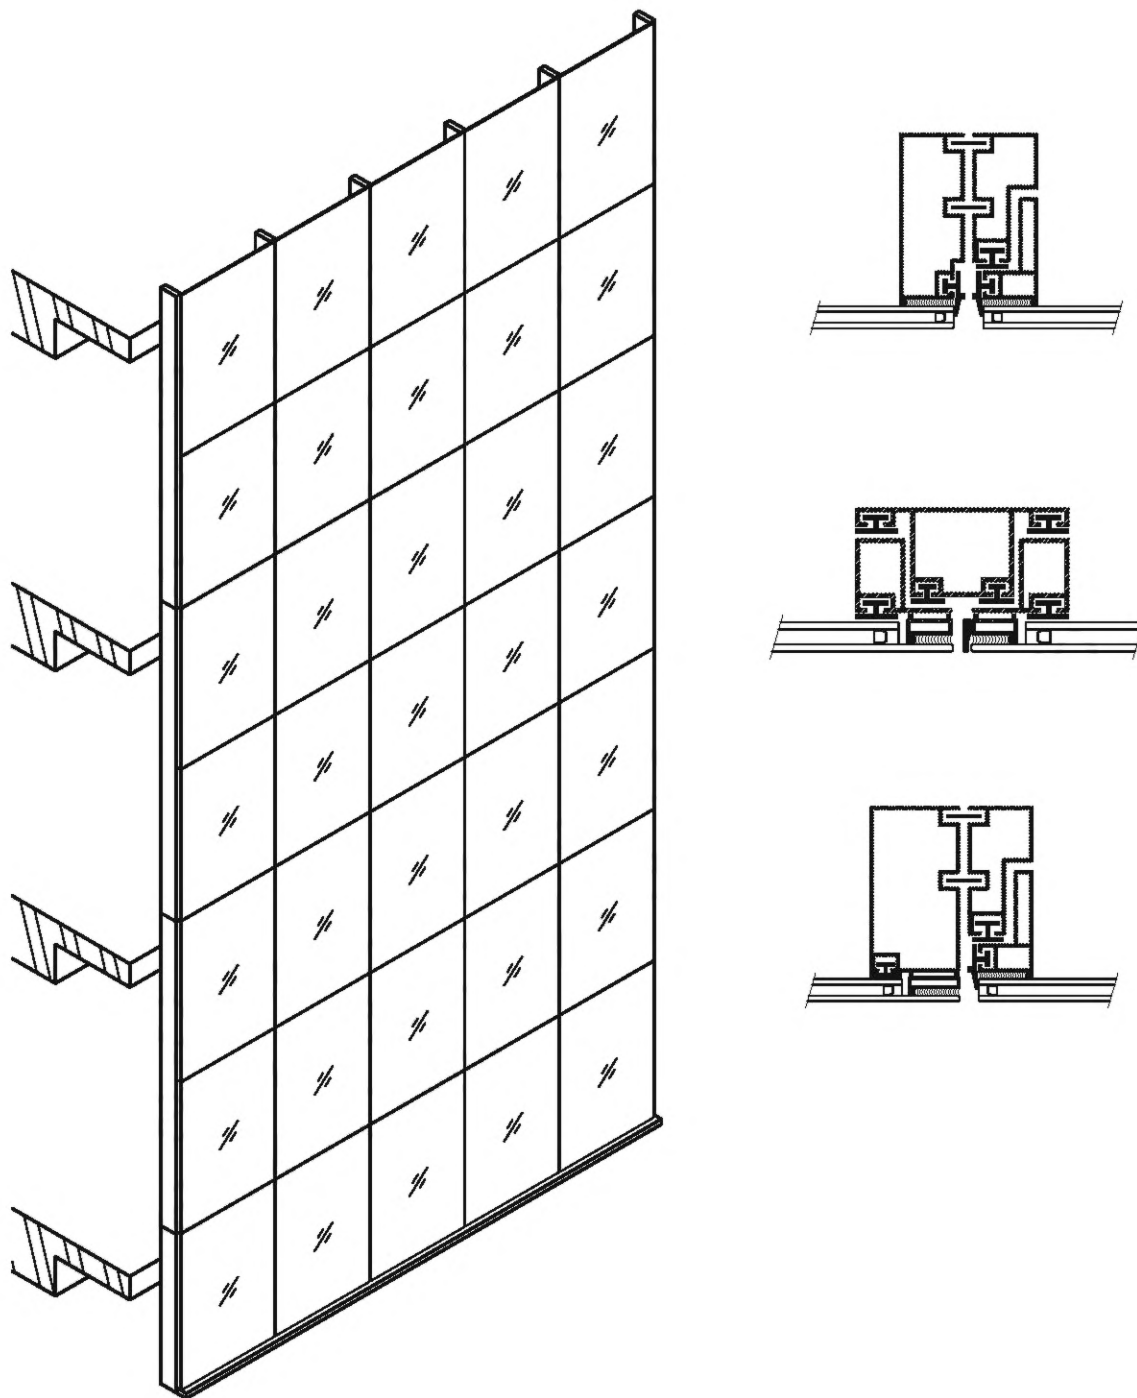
Пример фасадной светопрозрачной конструкции с клеевым остеклением
